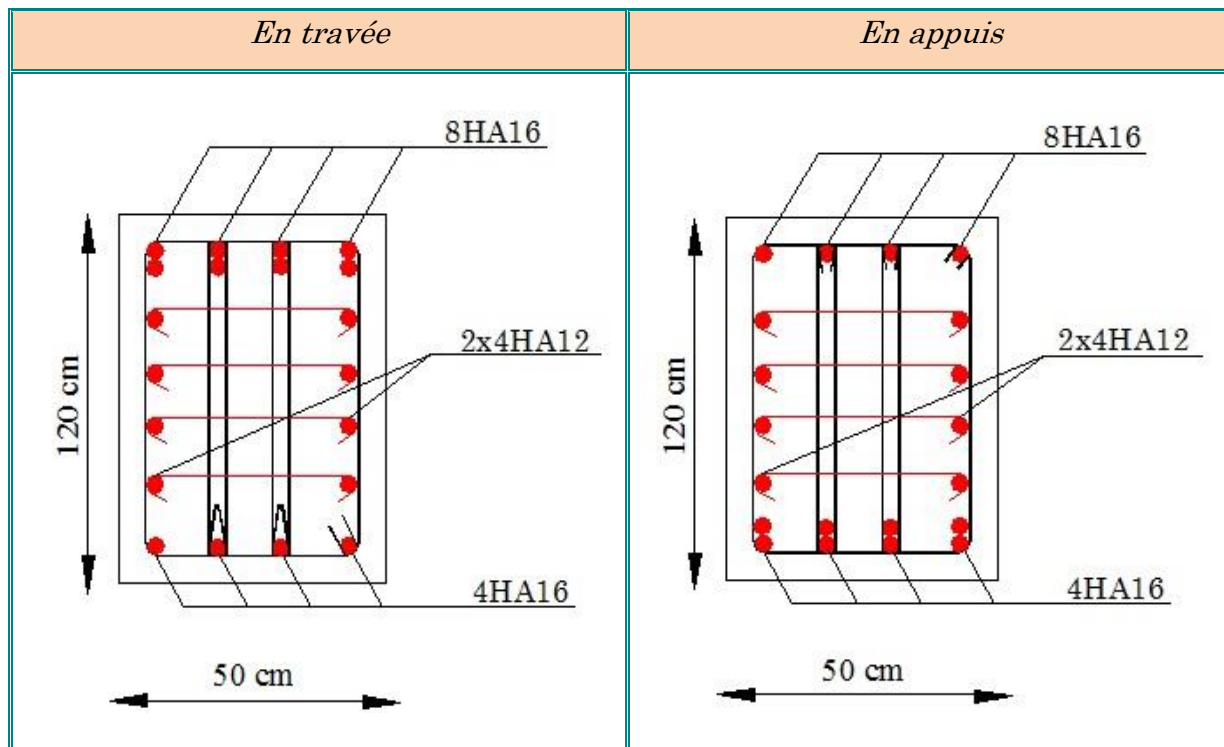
Coupe de ferrailage des nervures aux niveaux des appuis et travée.
